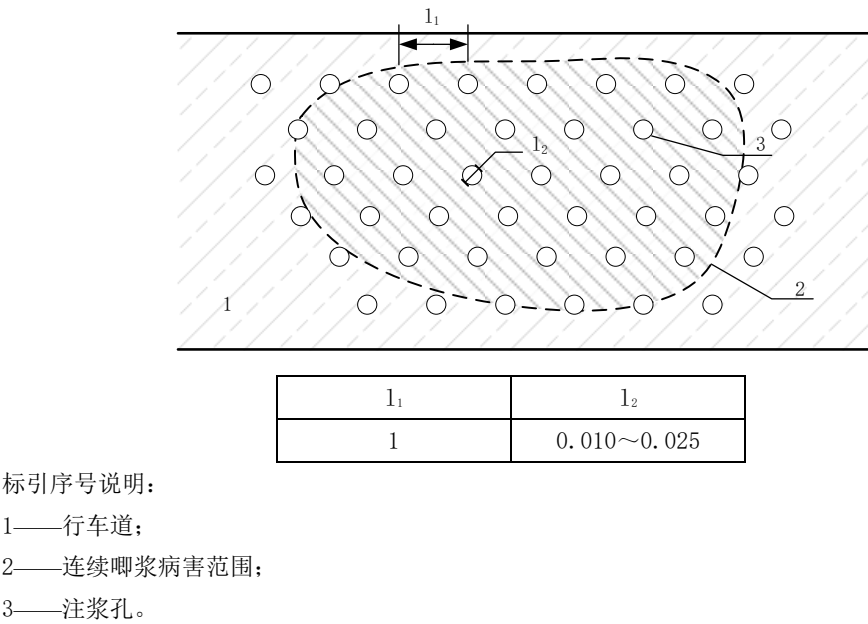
连续唧浆病害路段整车道处治注浆孔布置平面图
